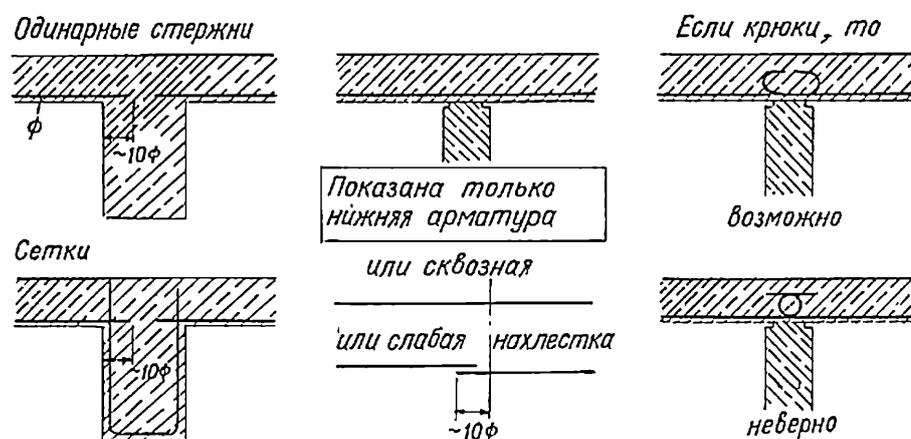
II. Заделка нижней арматуры на промежуточных опорах (верхняя арматура не указана)
